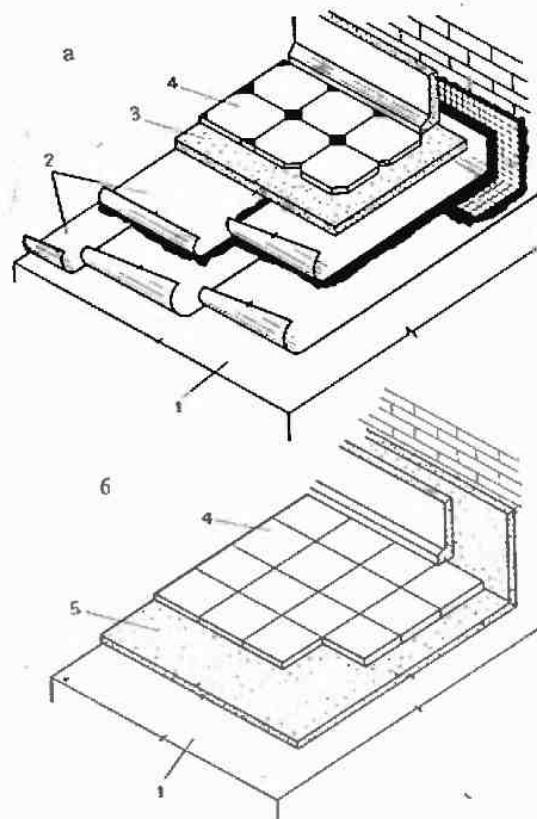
Перекрытия в санитарных узлах и малых помещениях
